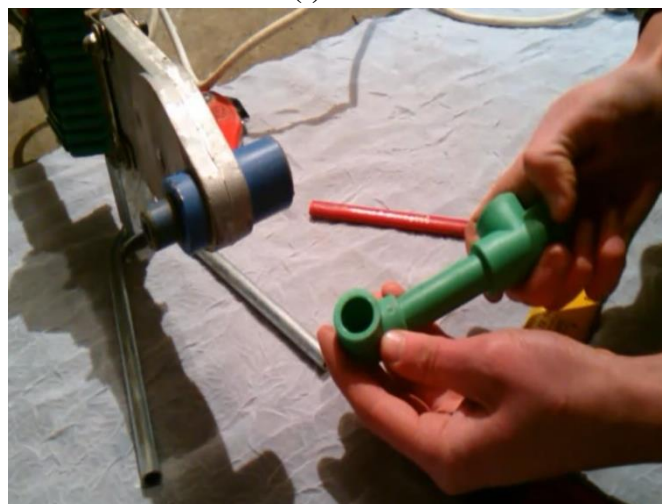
(c) Ocrtavanje i provjeravanje dimenzija PVC cijevi;
